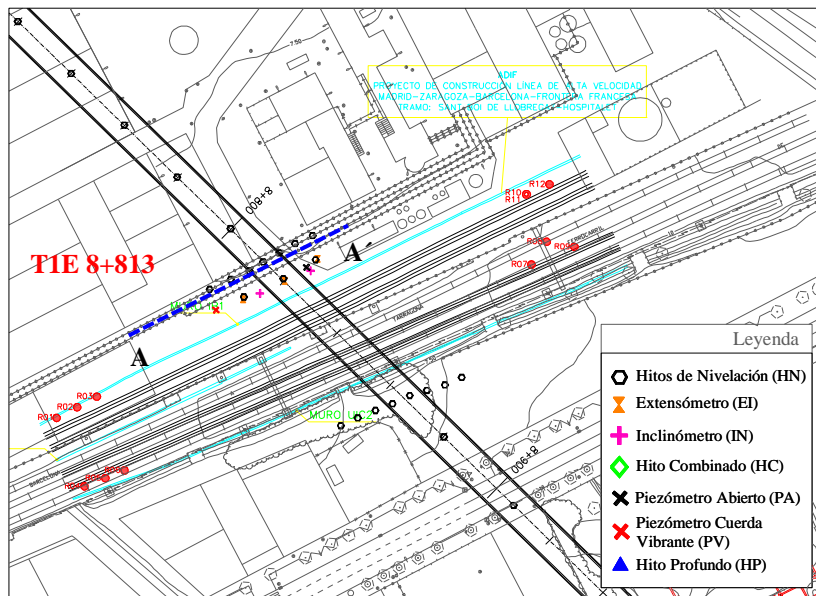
43. Situación en planta del túnel y la sección de control TIE PK 8+813
